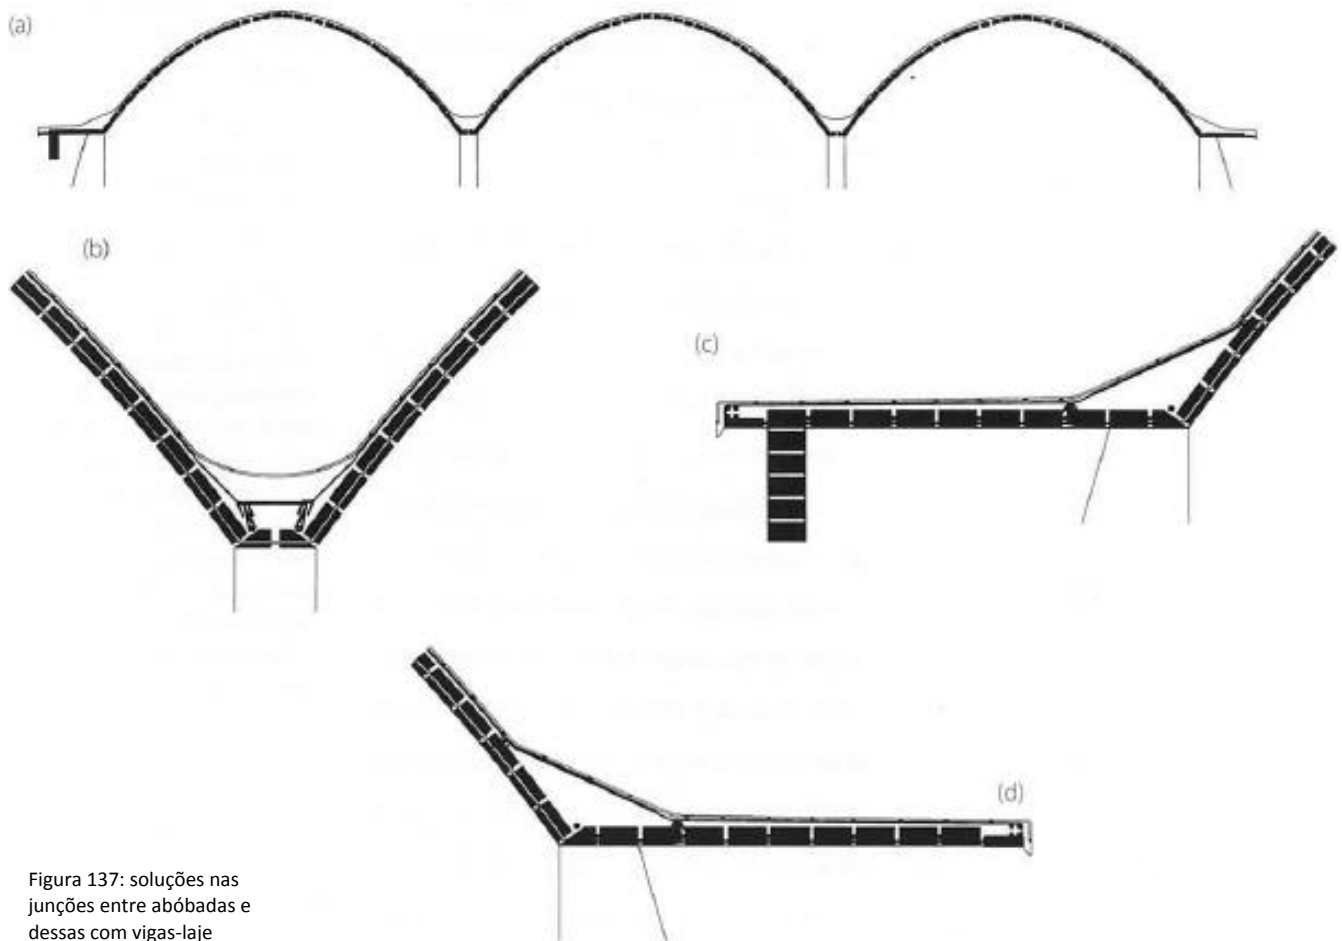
soluções nas junções entre abóbadas e dessas com vigas-laje
